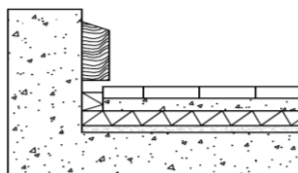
Pormenor do sistema de lajeta flutuante
